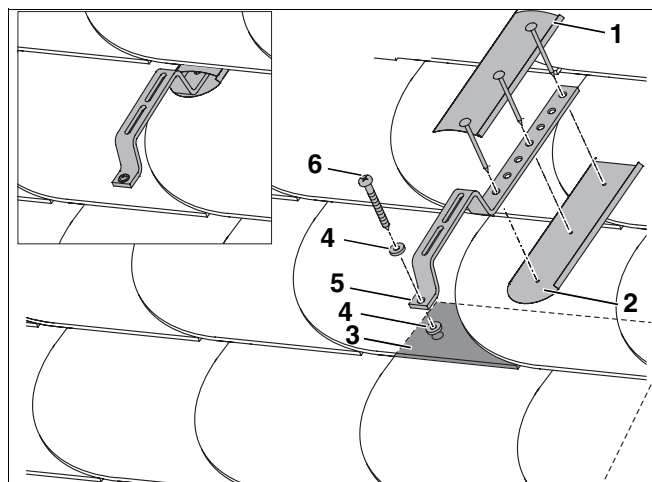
Montage sur les toits de bardeaux/d'ardoises
